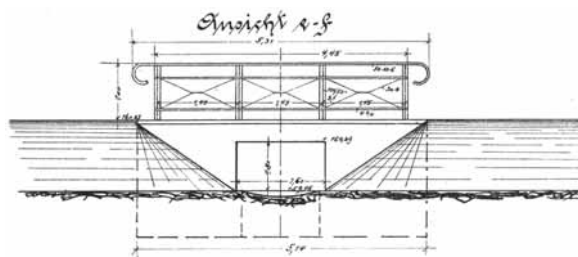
Tradycyjna żelbetowa konstrukcja ramowa stosowana do budowy przepustów [4]
